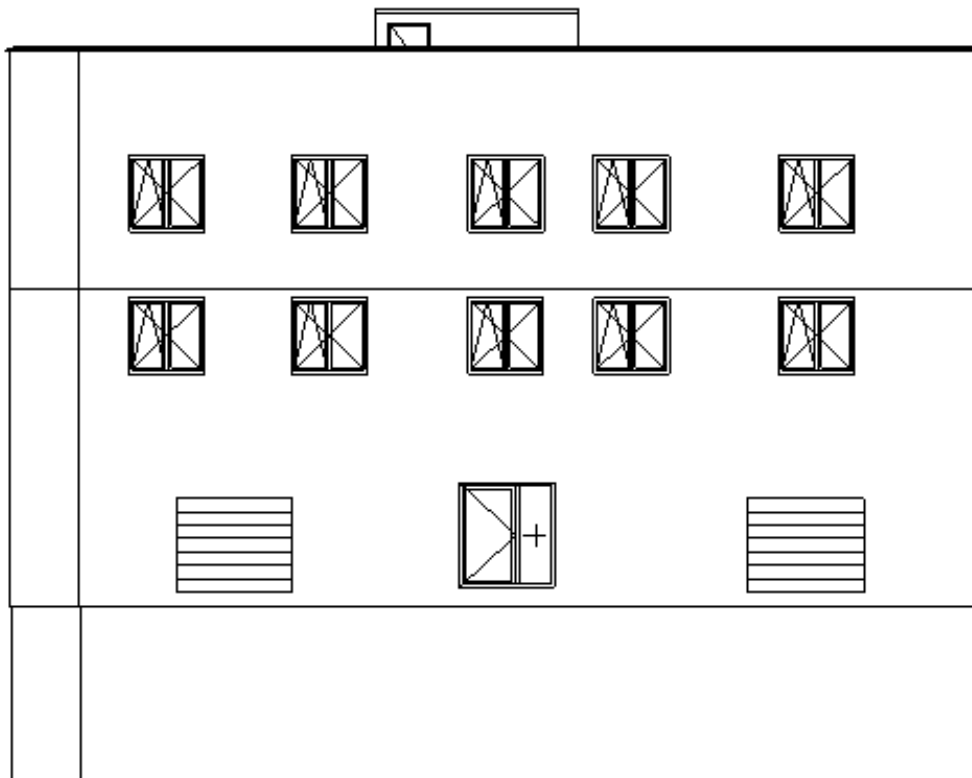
Alzado principal. Fuente: Propia (2019)
